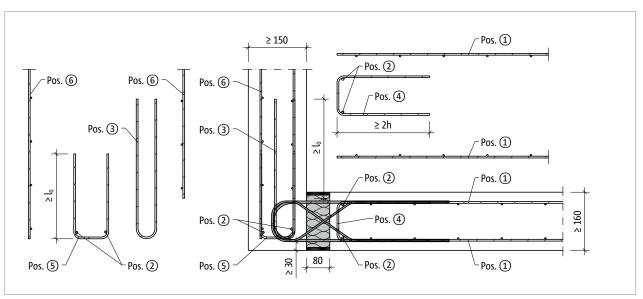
Schöck Isokorb® T tipo AP: disposizione orizzontale, armatura in opera
